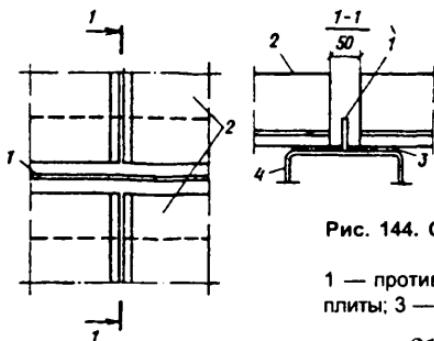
Опирание асбестоцементных экструзионных плит на прогон покрытия:
